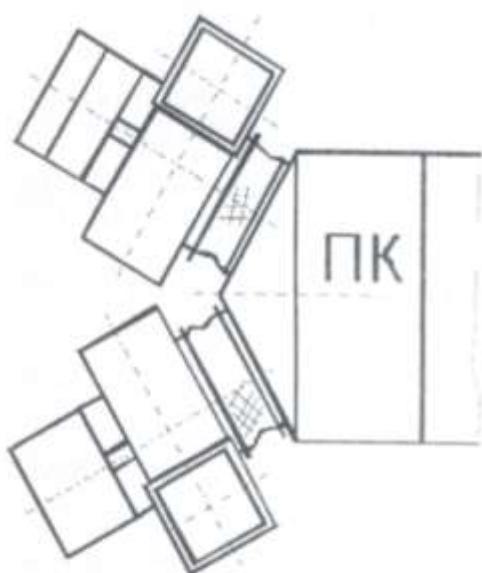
Фрагмент приточной камеры, используемой для цели воздушного отопления с двумя параллельно установленными вентиляторами, основным и резервным
